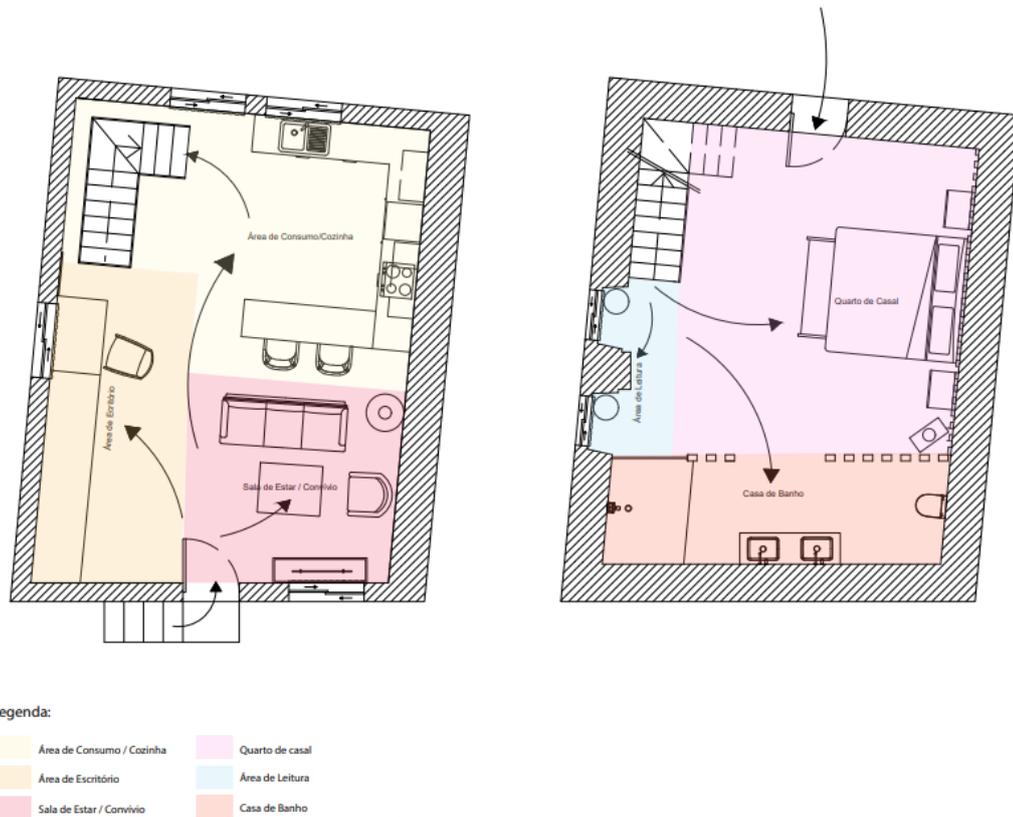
Planta de zoneamento e circulação. Fonte: Maria Leonor.
